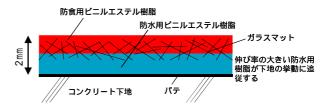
FRPシートの断面構成 Section of Waterproofing and Corrosion-proofing Layers Applied to Qu² System
